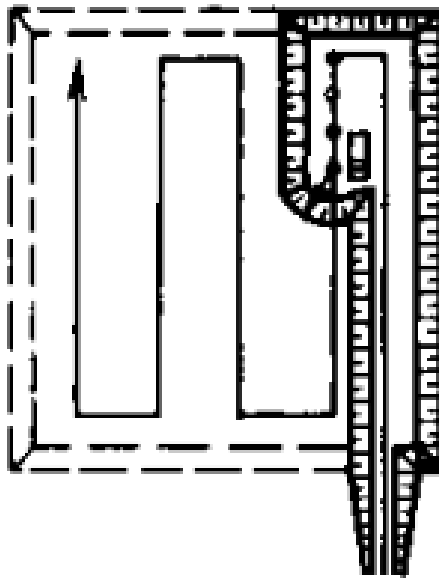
Схема розробки котловану житлової будівлі.
